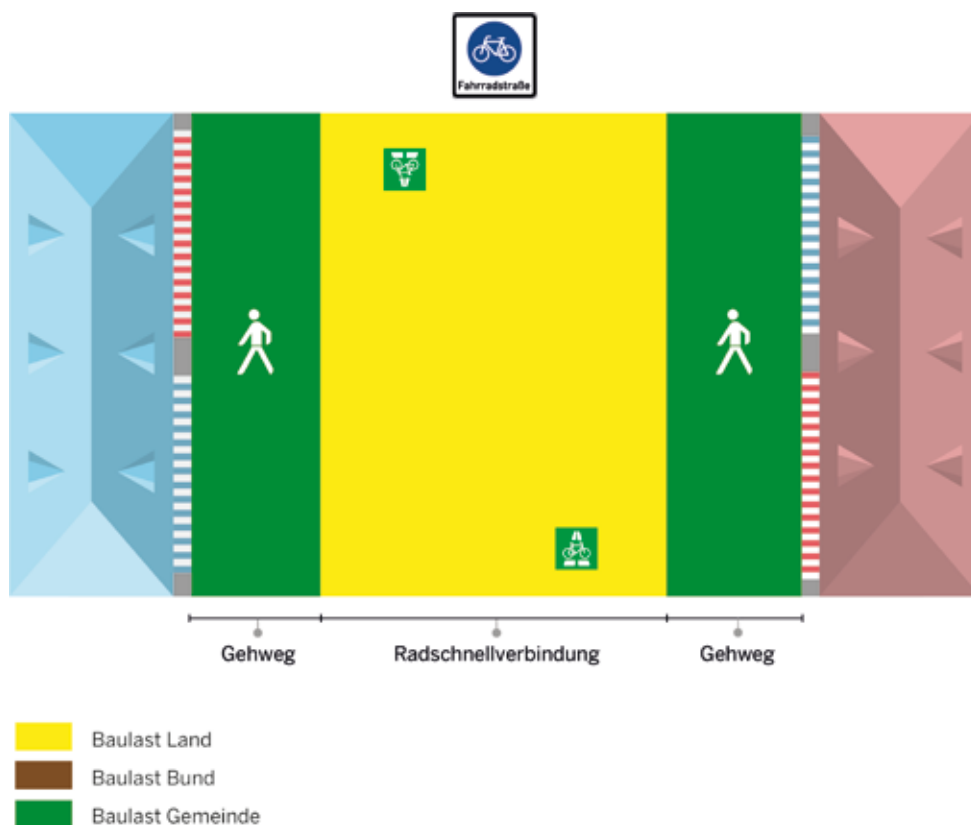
Fahrradstraße: Baulast längsgeteilt
